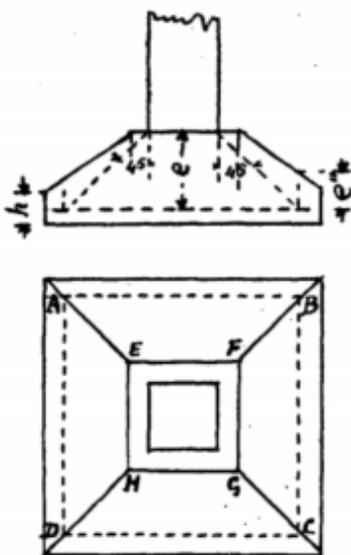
Cimentación apoyo aislado (Fernández, 1936a)
